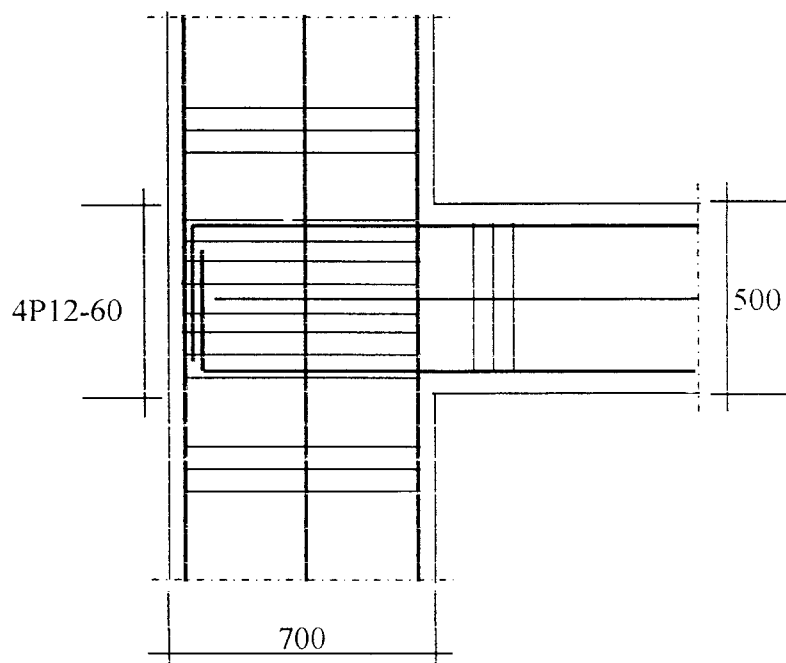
Detail Joint Balok-Kolom D Lantai 12
